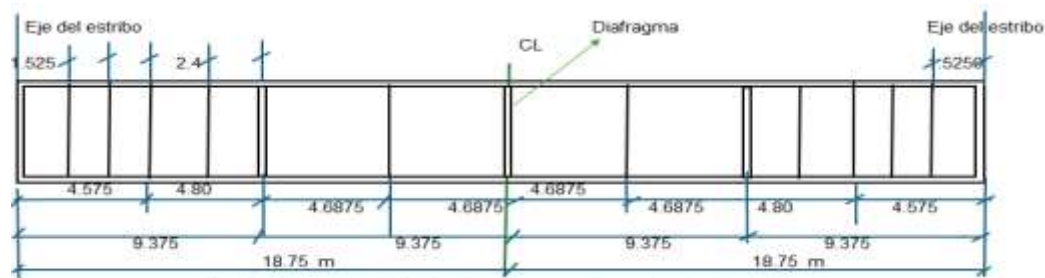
Disposición de rigidizadores transversales en la viga de acero
